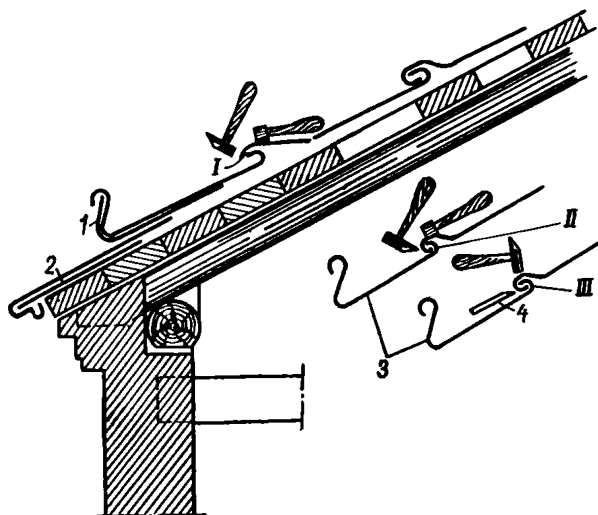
Соединение картин настенного желоба и рядового покрытия лежащим фальцем
